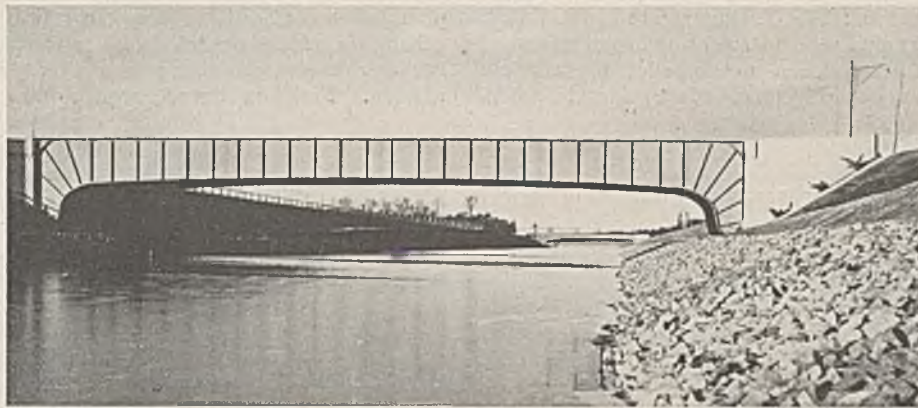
Milititzer Straßenbrücke (Länge 45 m, Breite 9 m).
